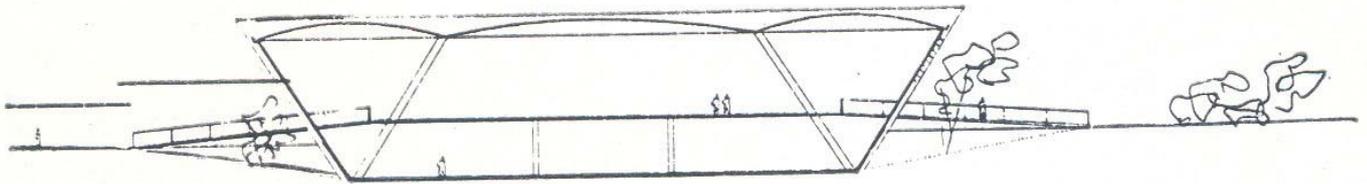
Corte do Pavilhão dos Estados correspondente à primeira versão do projeto. Observar a concepção estrutural com sistema de pilares oblíquos convergentes para um ponto na base. Observar, ainda, que o pavimento superior, destinado às exposições, era sustentado por duas outras linhas de apoio. Fonte: Revista Módulo, ano 1, nº 1, 1955.
